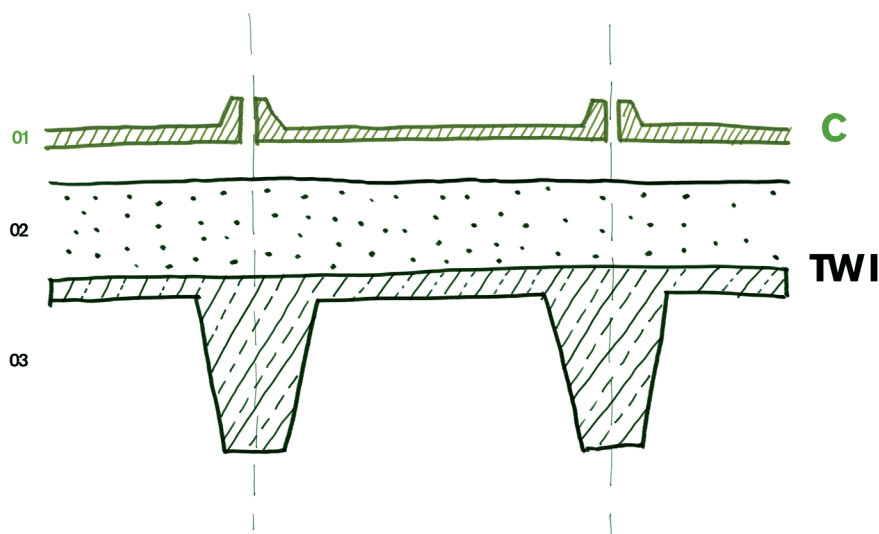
Skizzenhafte Darstellung des Dachaufbaus, Fallstudie ETA-Fabrik
